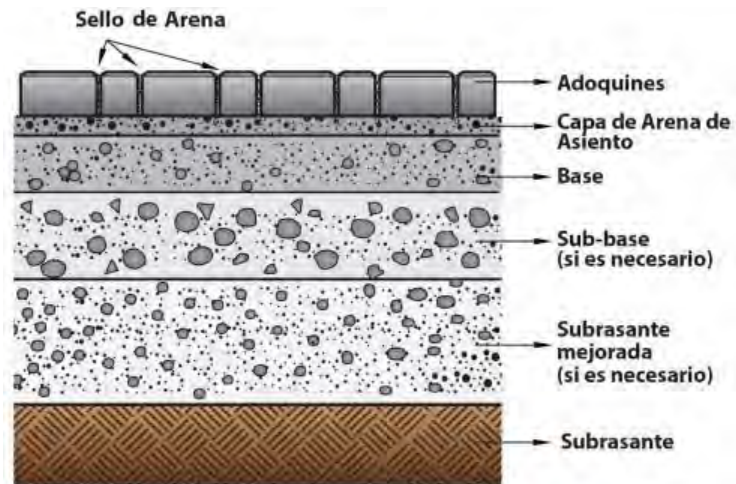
Estructura de Adoquines con juntas abiertas. Fuente: Instituto del Cemento y del Concreto de Guatemala
